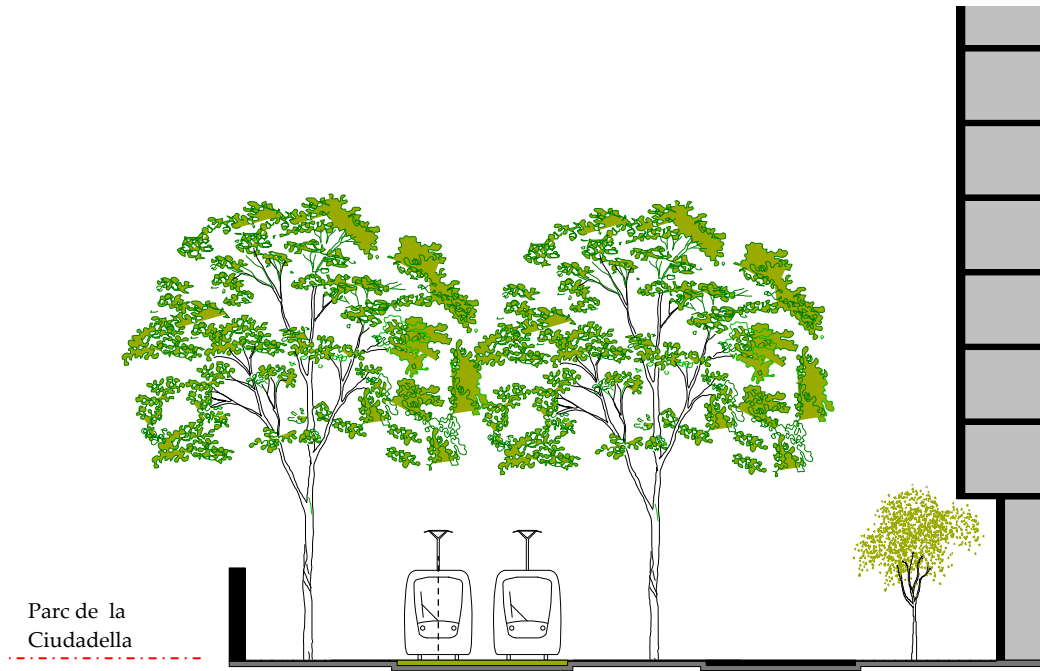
Sección transversal A-A. Fuente: elaboración propia.
